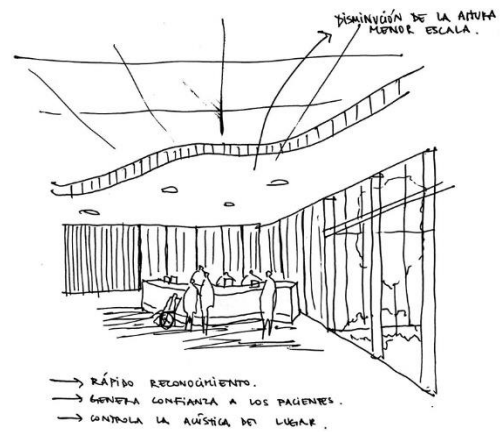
Croquis de detalle interior del proyecto. Fuente: Paula Fustos (2020).
